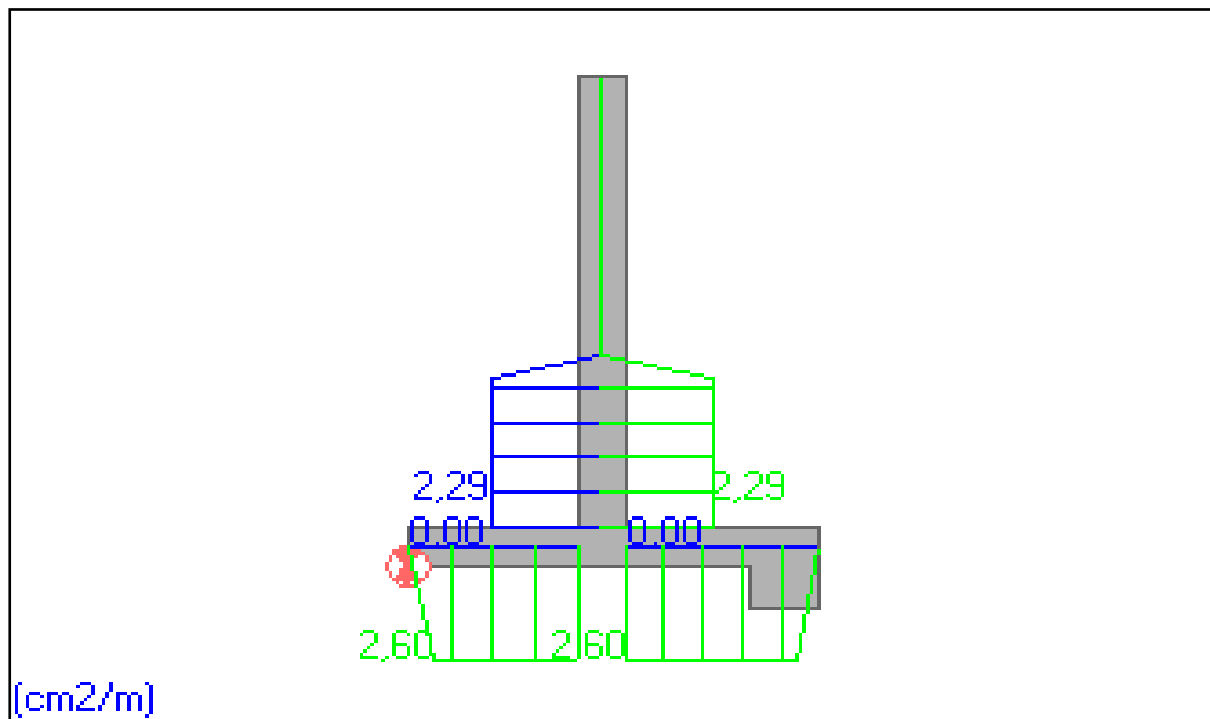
coupe sur le ferrailage du mur de soutènement
